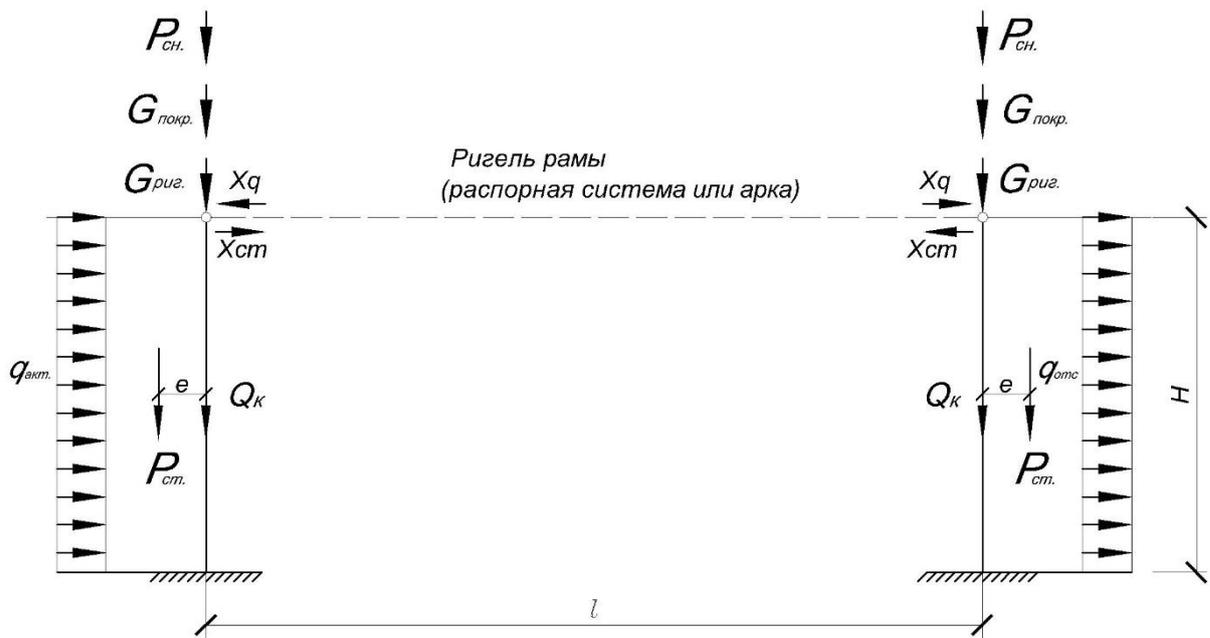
Расчетная схема колонны в составе поперечной рамы здания
